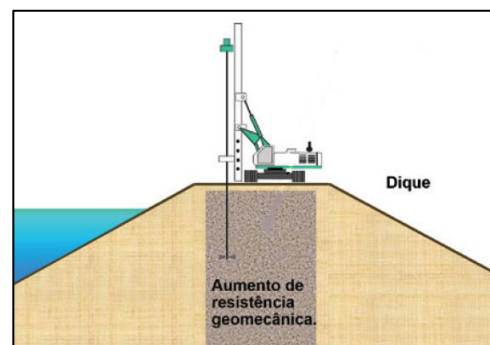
Jet-grouting* aplicado em barragens (Fonte: adaptado de COSTA FORTUNA, p. 06).
